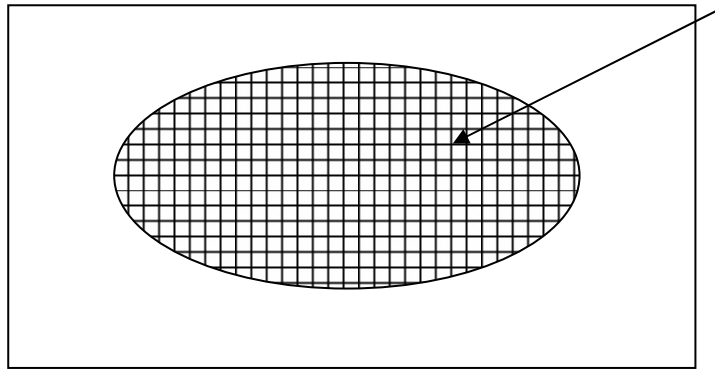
Schémas de ferrailage de la dalle de compression.
